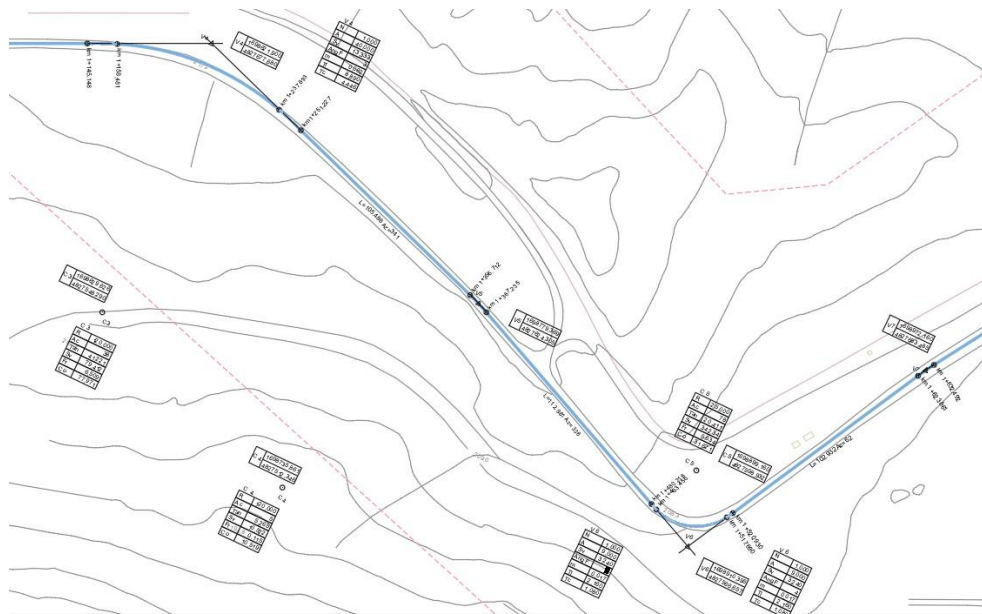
Stralcio Planimetria di Tracciamento Ramo Nord-Est
